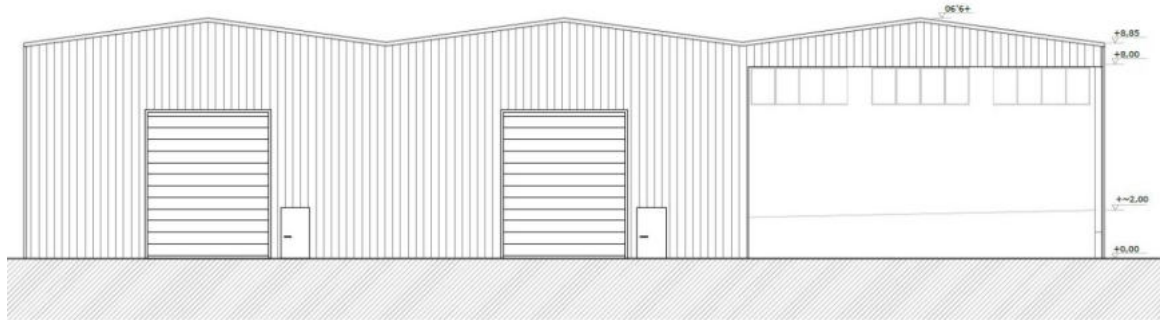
PROSPETTO SUD TETTOIA STOCCAGGI – Stato di progetto
